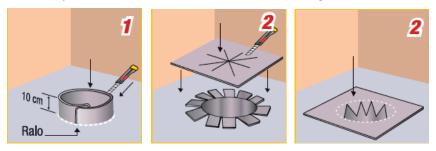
Detalhe da execução do reforço da impermeabilização dos ralos
